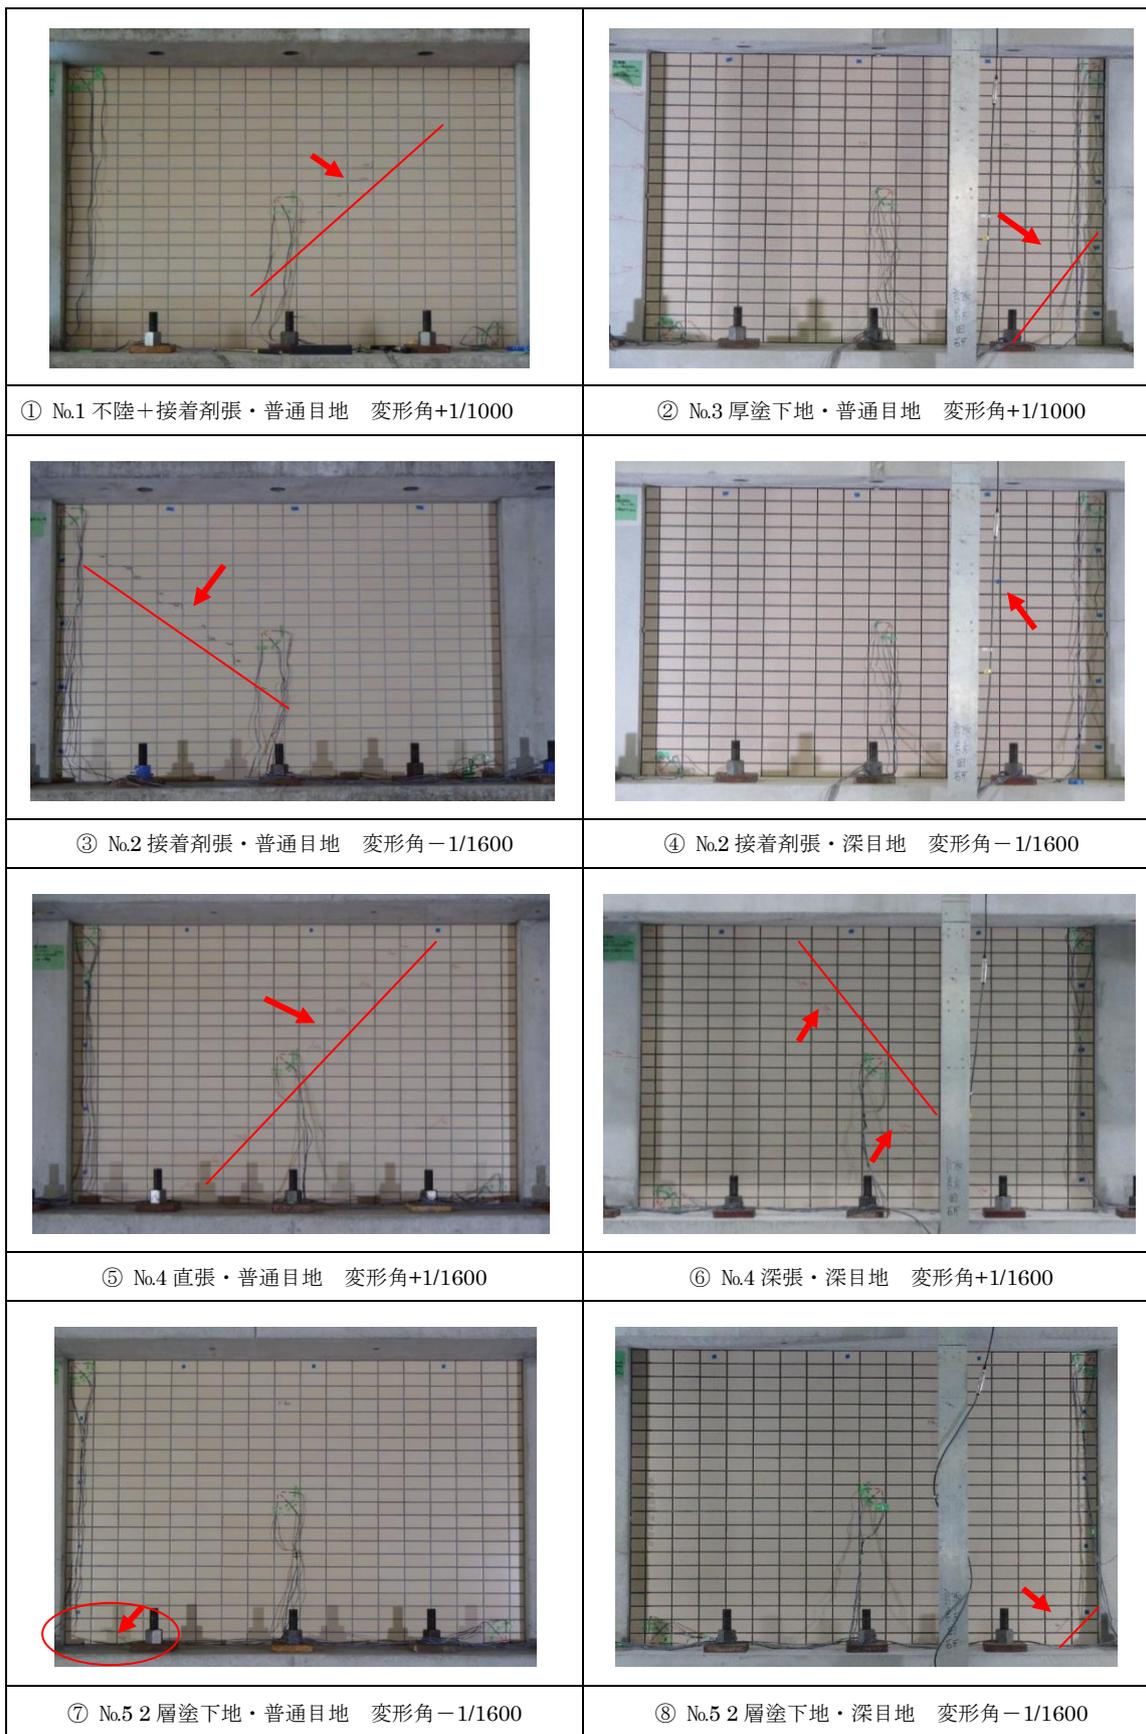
初期ひび割れの入った層間変形角とタイル仕上げの状態
